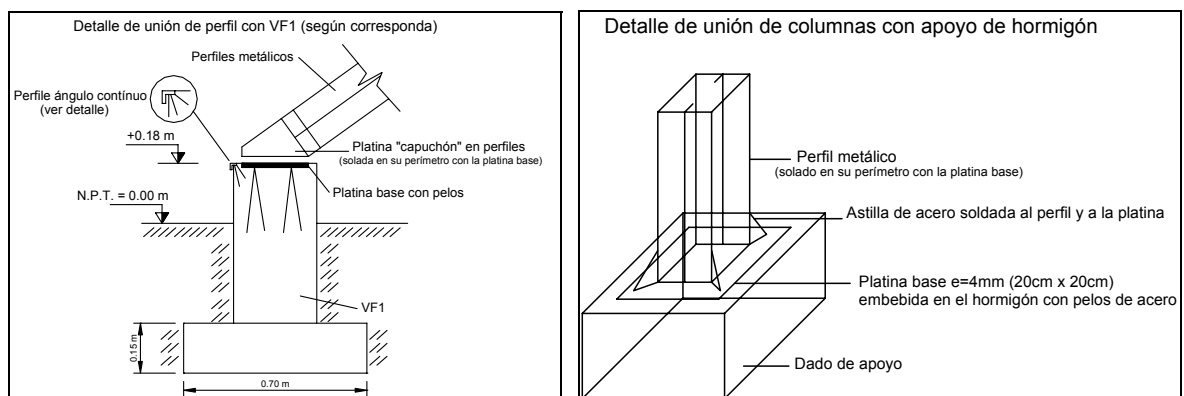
Esquemas de vigas de arranques y columnas metálicas de escalera. (Ver también Capítulo 9).
